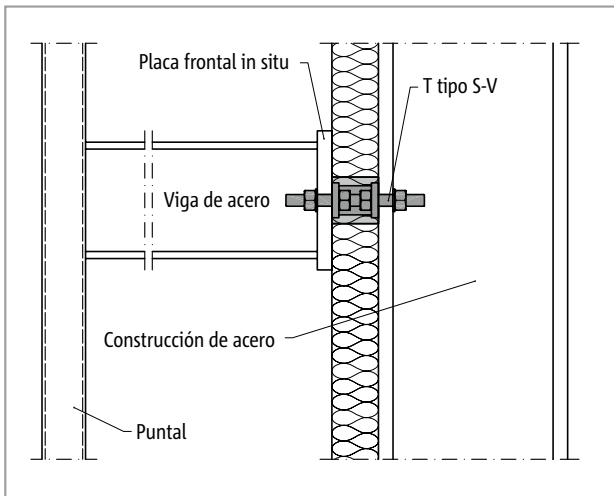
Schöck Isokorb® T tipo S-V: Construcción de acero apoyada
